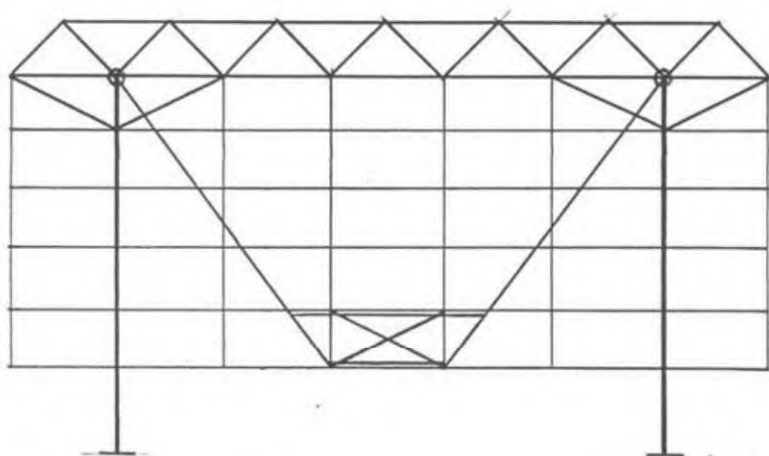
à 4.40 (suite) Quelques détails d'attaches de suspentes métalliques (croquis de cours de l'auteur).
